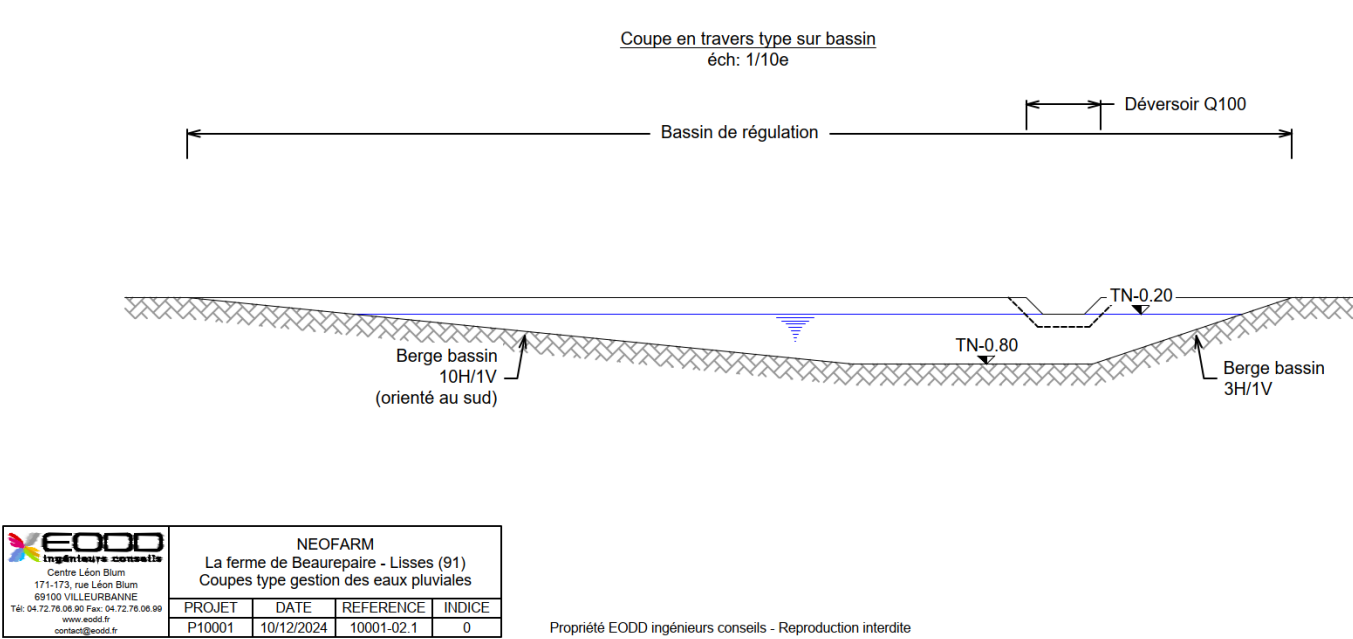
Coupe en travers de l'ouvrage du BV n°1
